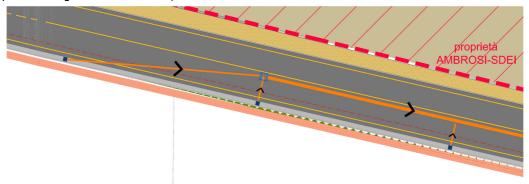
estratto sezione tipo: ubicazione caditoia stradale in banchina e collettore di drenaggio a centro strada
